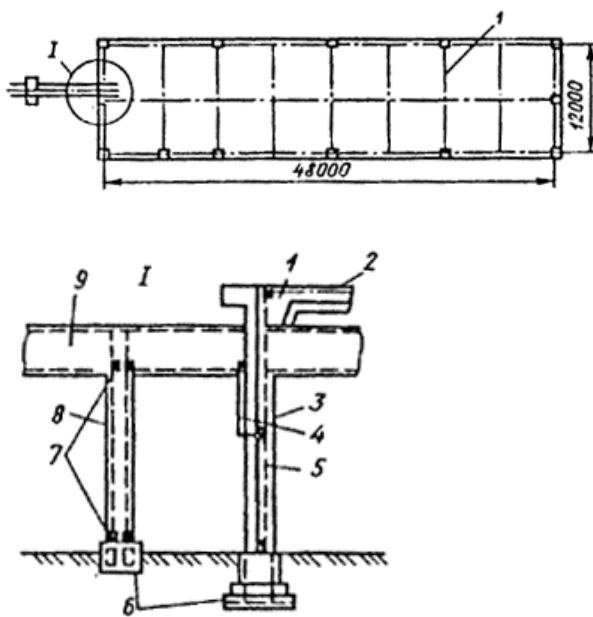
Молниезащита здания II категории сеткой, уложенной на кровлю под гидроизоляцию:
